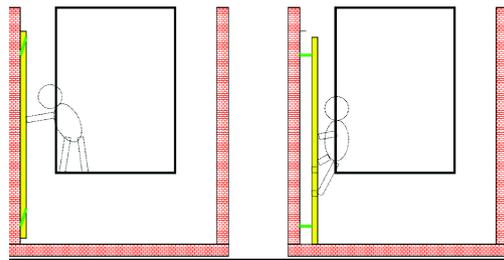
Typ 2a – Ausschwenkbare Schachtgrubenleiter
